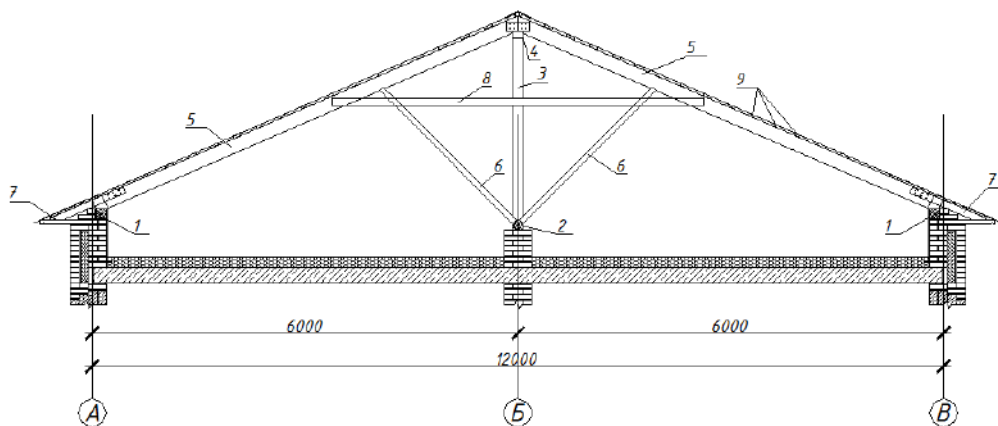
Общий вид стропильной системы с наслонными стропилами
